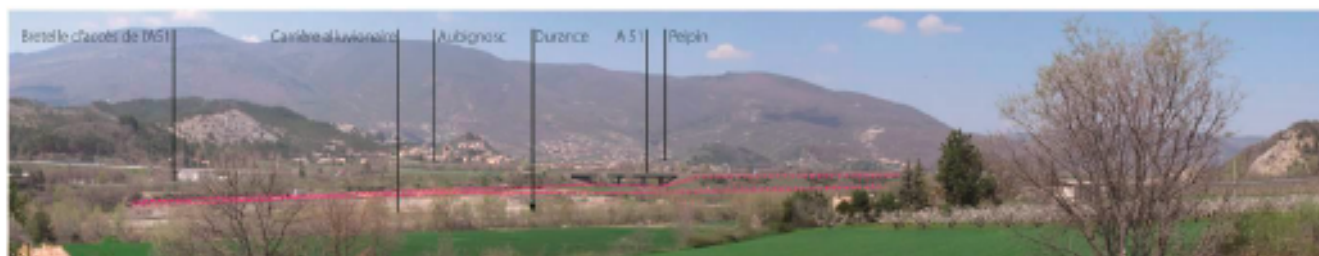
Vue depuis le lieu-dit Plan de Volonne
